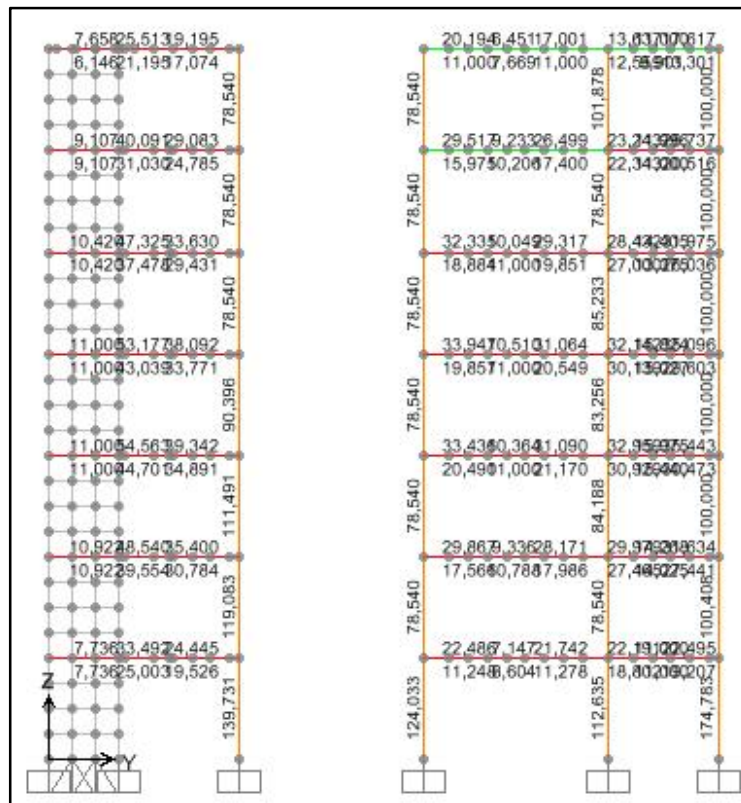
Acero en vigas pórtico 10, Hall Central
